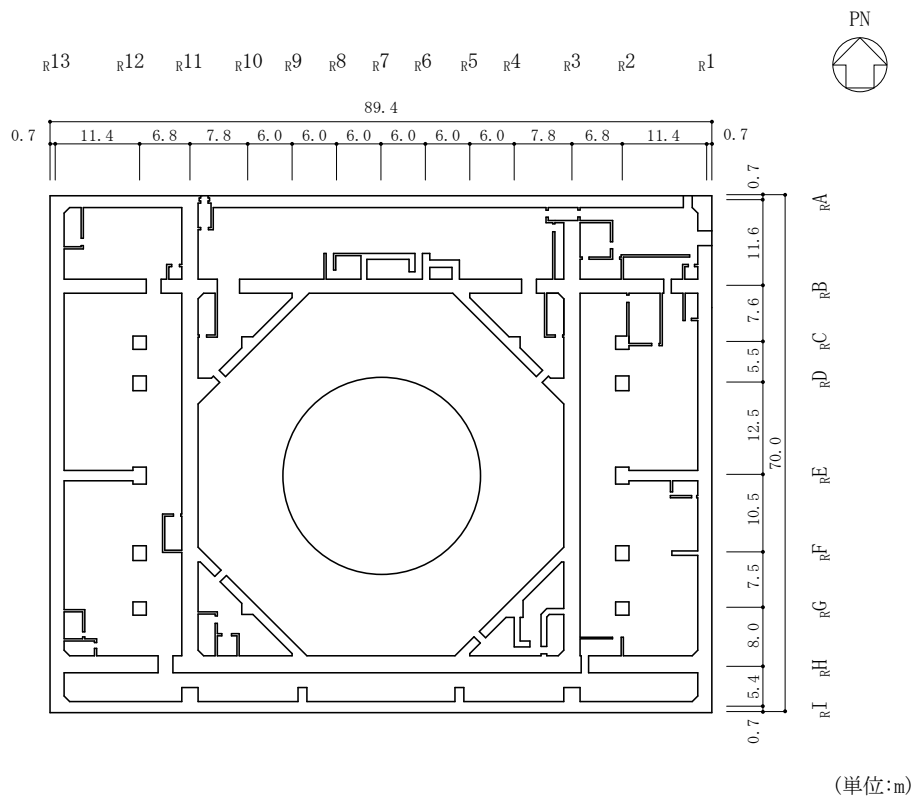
(2) 原子炉建物の概略平面図 (EL 8.8m)
